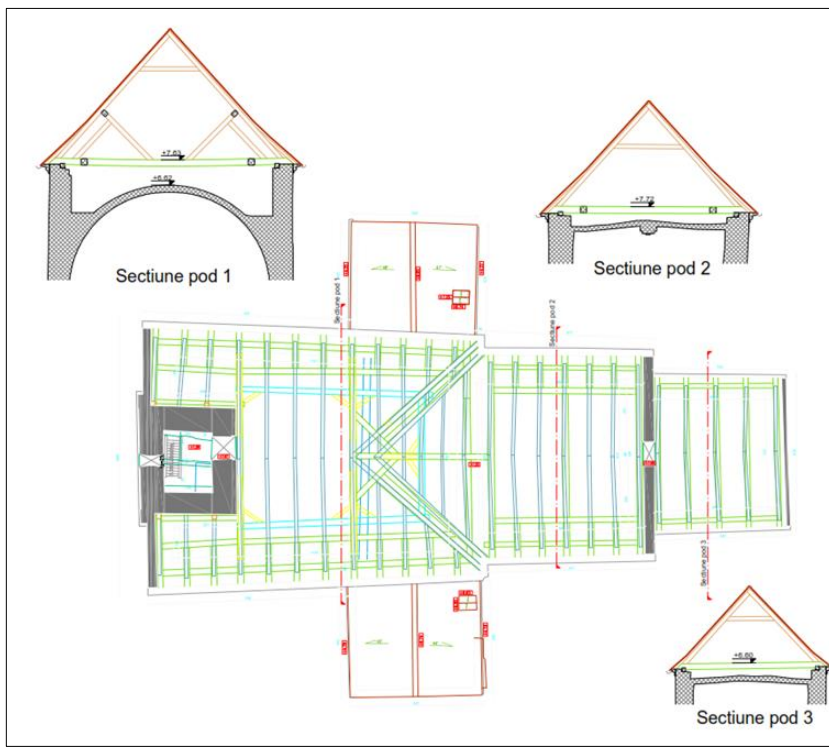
Plan și secțiune longitudinală (2019, ArenaCAD).
